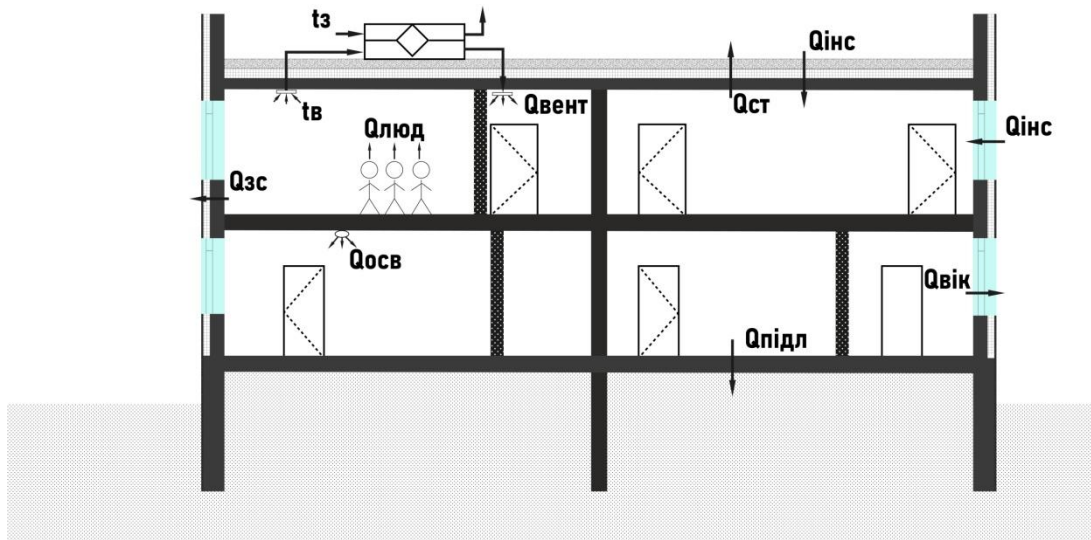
Розрахункова схема до моделювання теплового розрахунку будівлі
